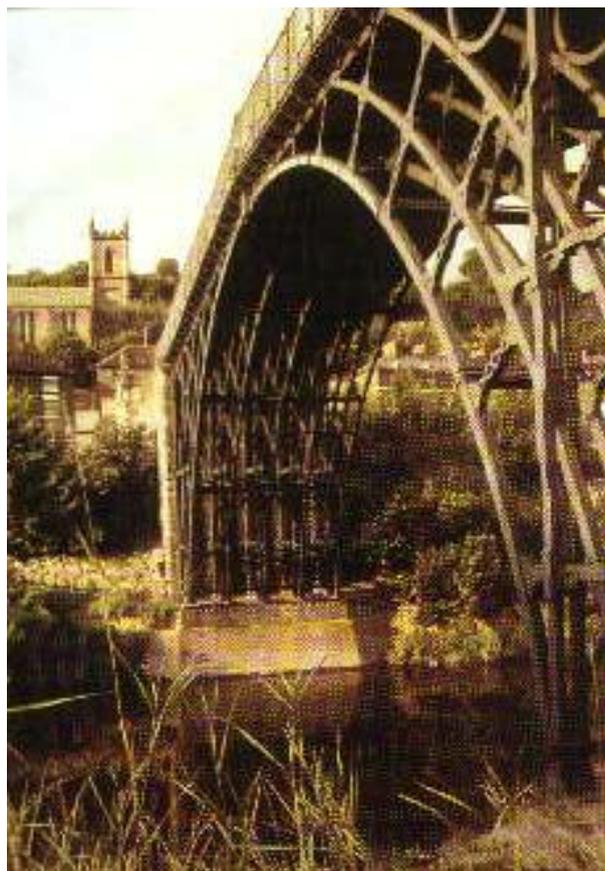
Coalbrookdale, arco em ferro fundido, com detalhes inspirados nas construções de madeira.
